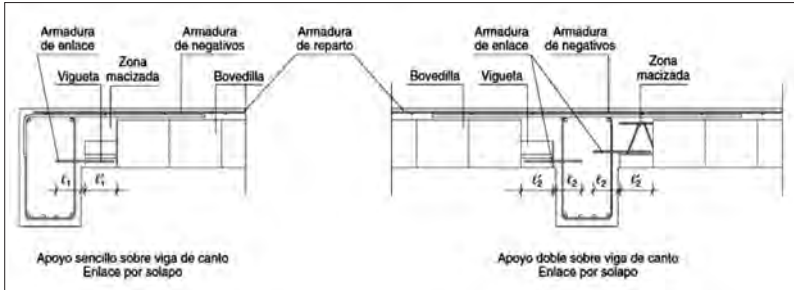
y 18: apoyo sobre viga de canto. Enlace por solapo.
